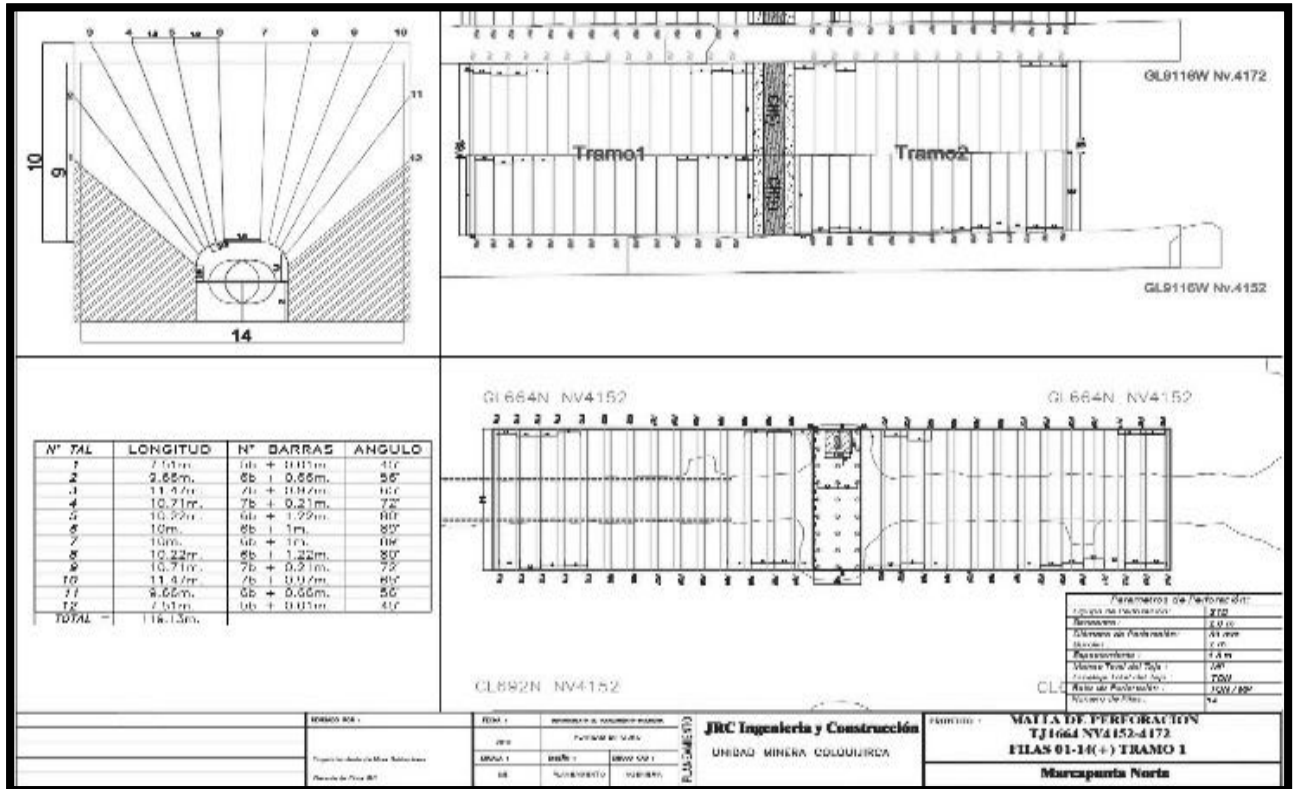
Proyecto de perforación Tj-636N con un ancho de 14 m
